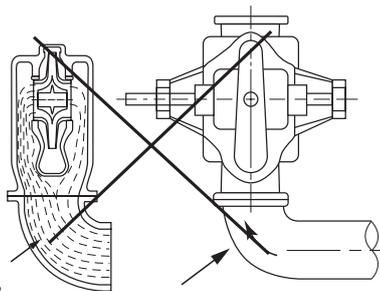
Рекомендованный монтаж всасывающего трубопровода и длина прямого трубопровода между горизонтальным коленом и насосом
